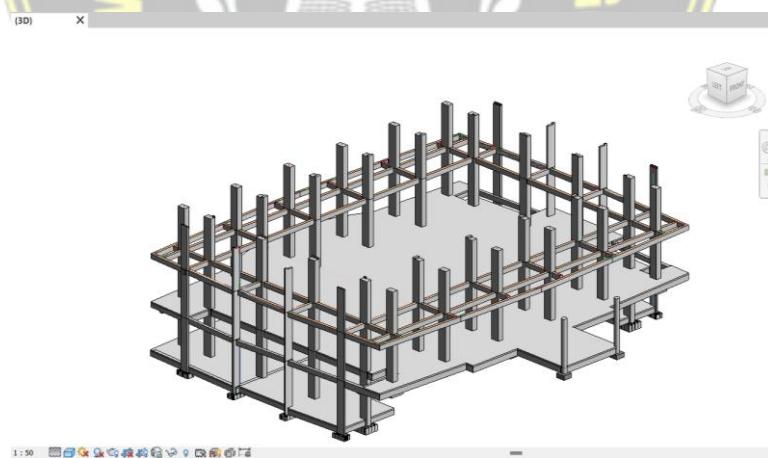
21 Tampilan Pemodelan Kolom Lantai 1
